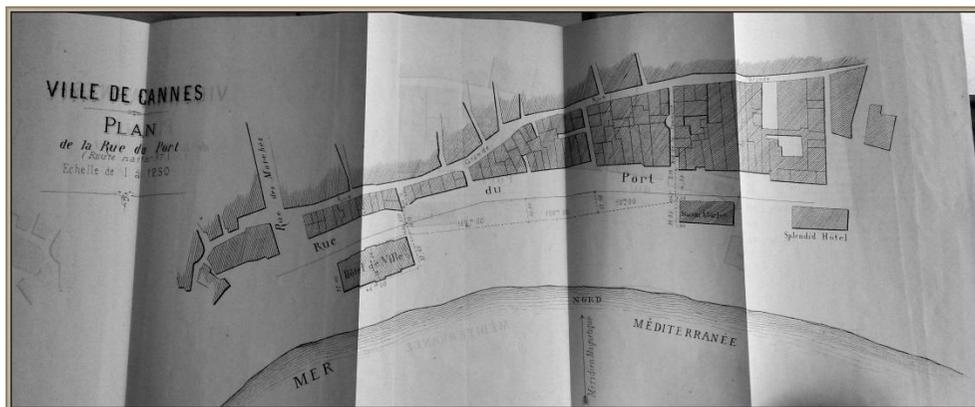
Plan d'implantation des bâtiments, dossier de concours
